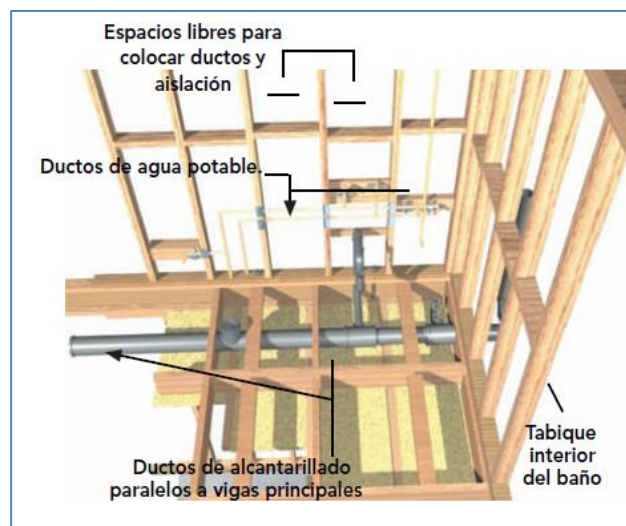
Colocación de ductos de alcantarillado y agua potable en los espacios que generan las estructuras de madera.
